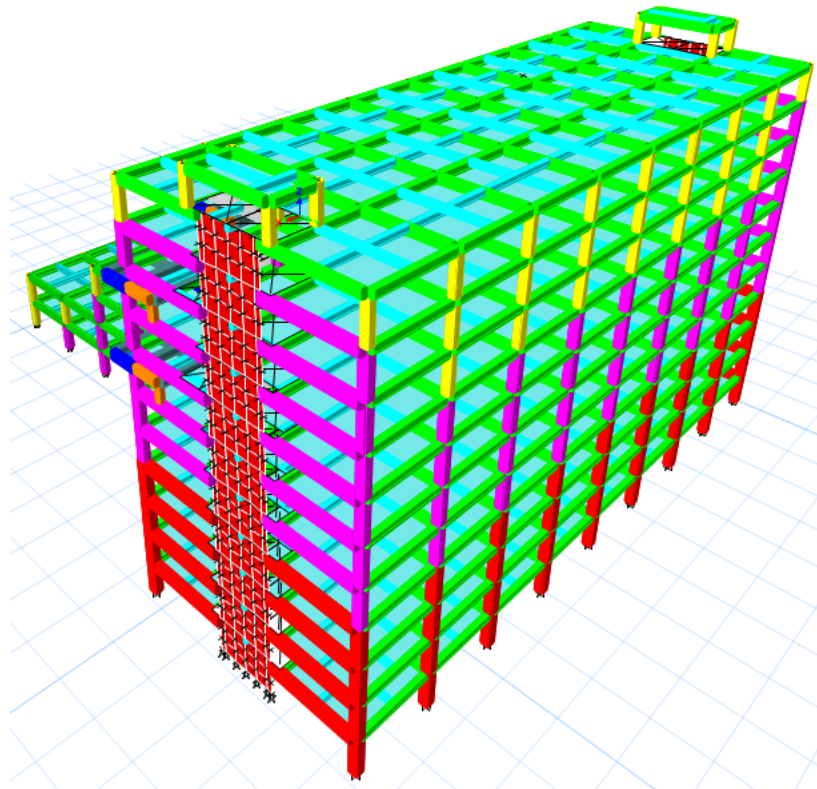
Tiga Dimensi Gedung Tampak Belakang Model 2
